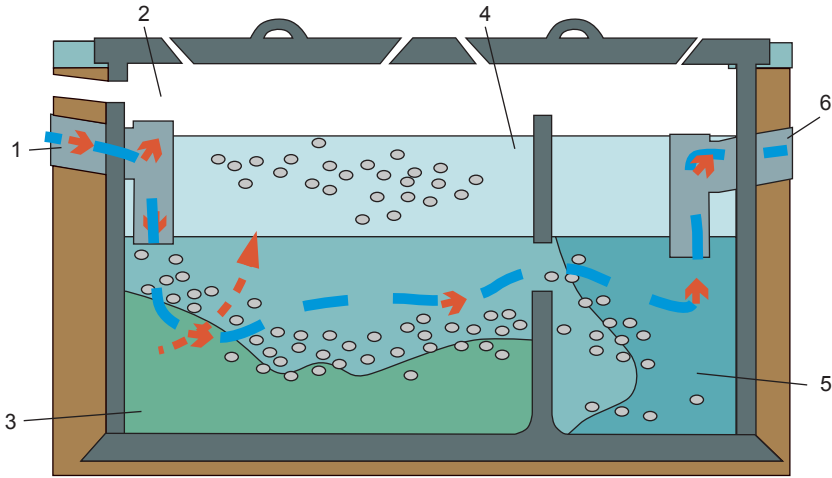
Устройство двухкамерного септика: 1 — вход; 2 — воздух; 3 — ил; 4 — корка; 5 — минеральный осадок; 6 — выход
